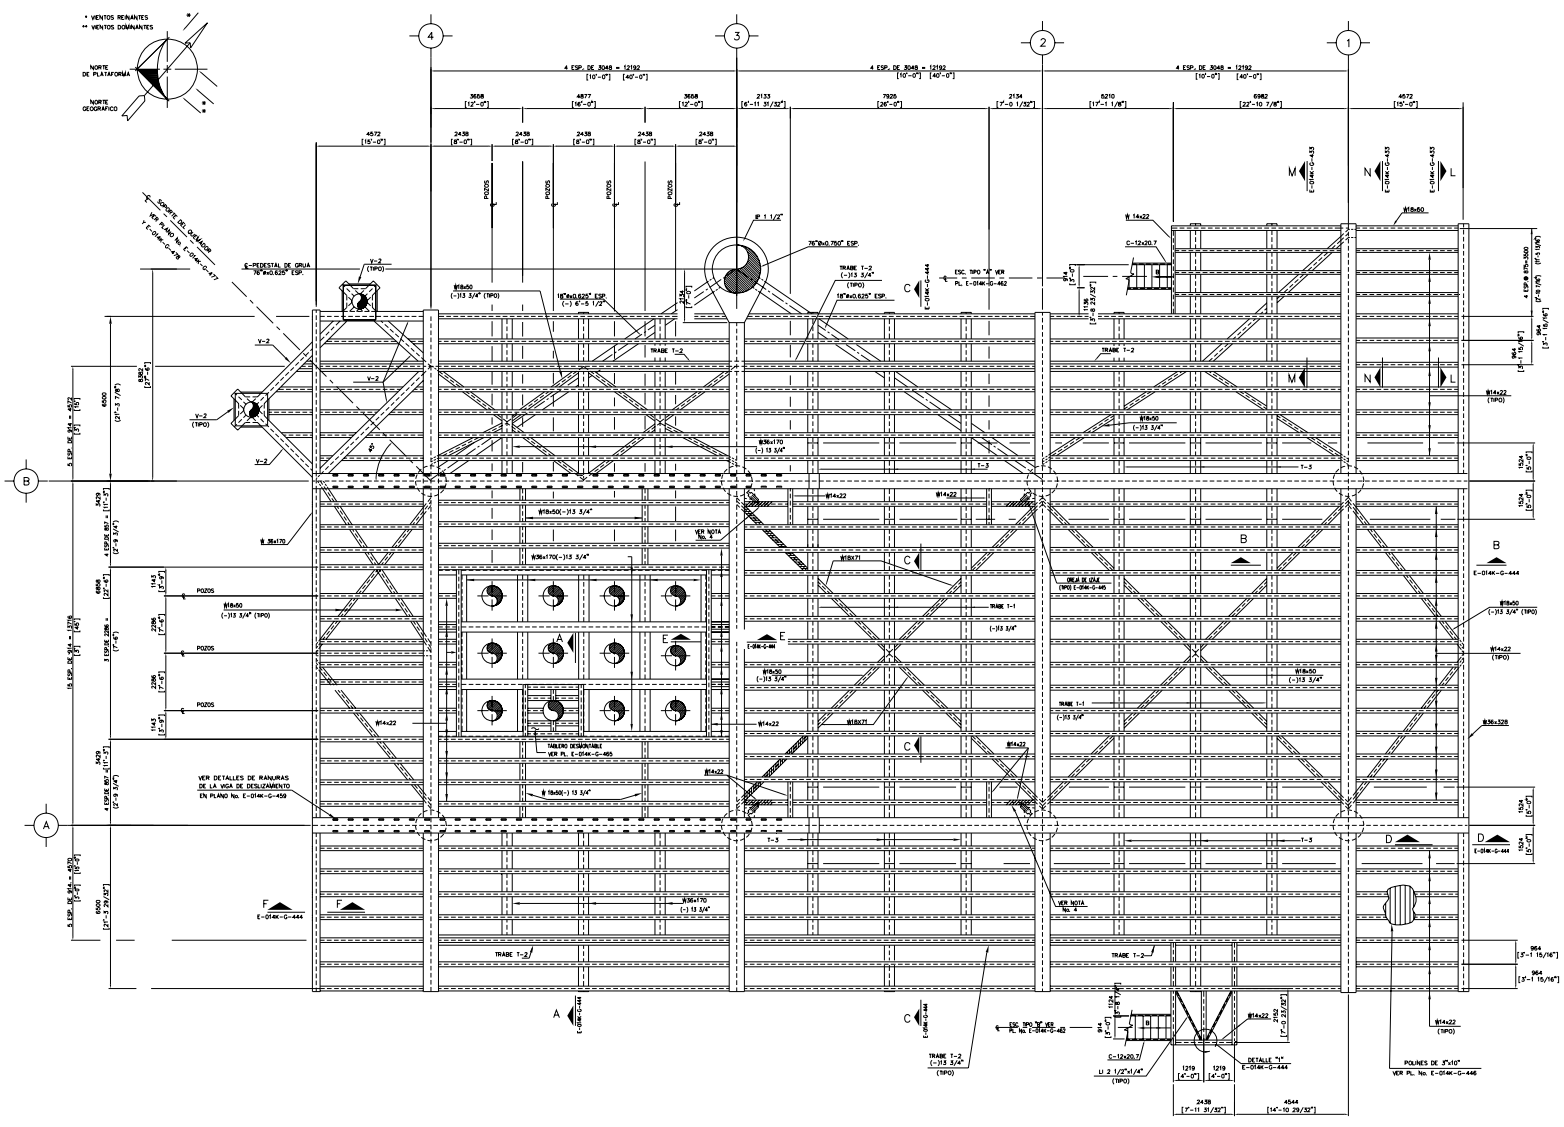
Planta estructural de la cubierta principal nivel (+) 25.500 (83'-7 15/16").
